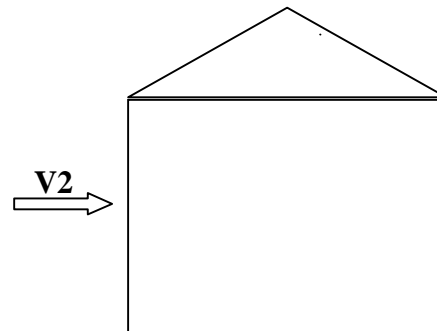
Vent sur la façade gauche et droite du hangar.
